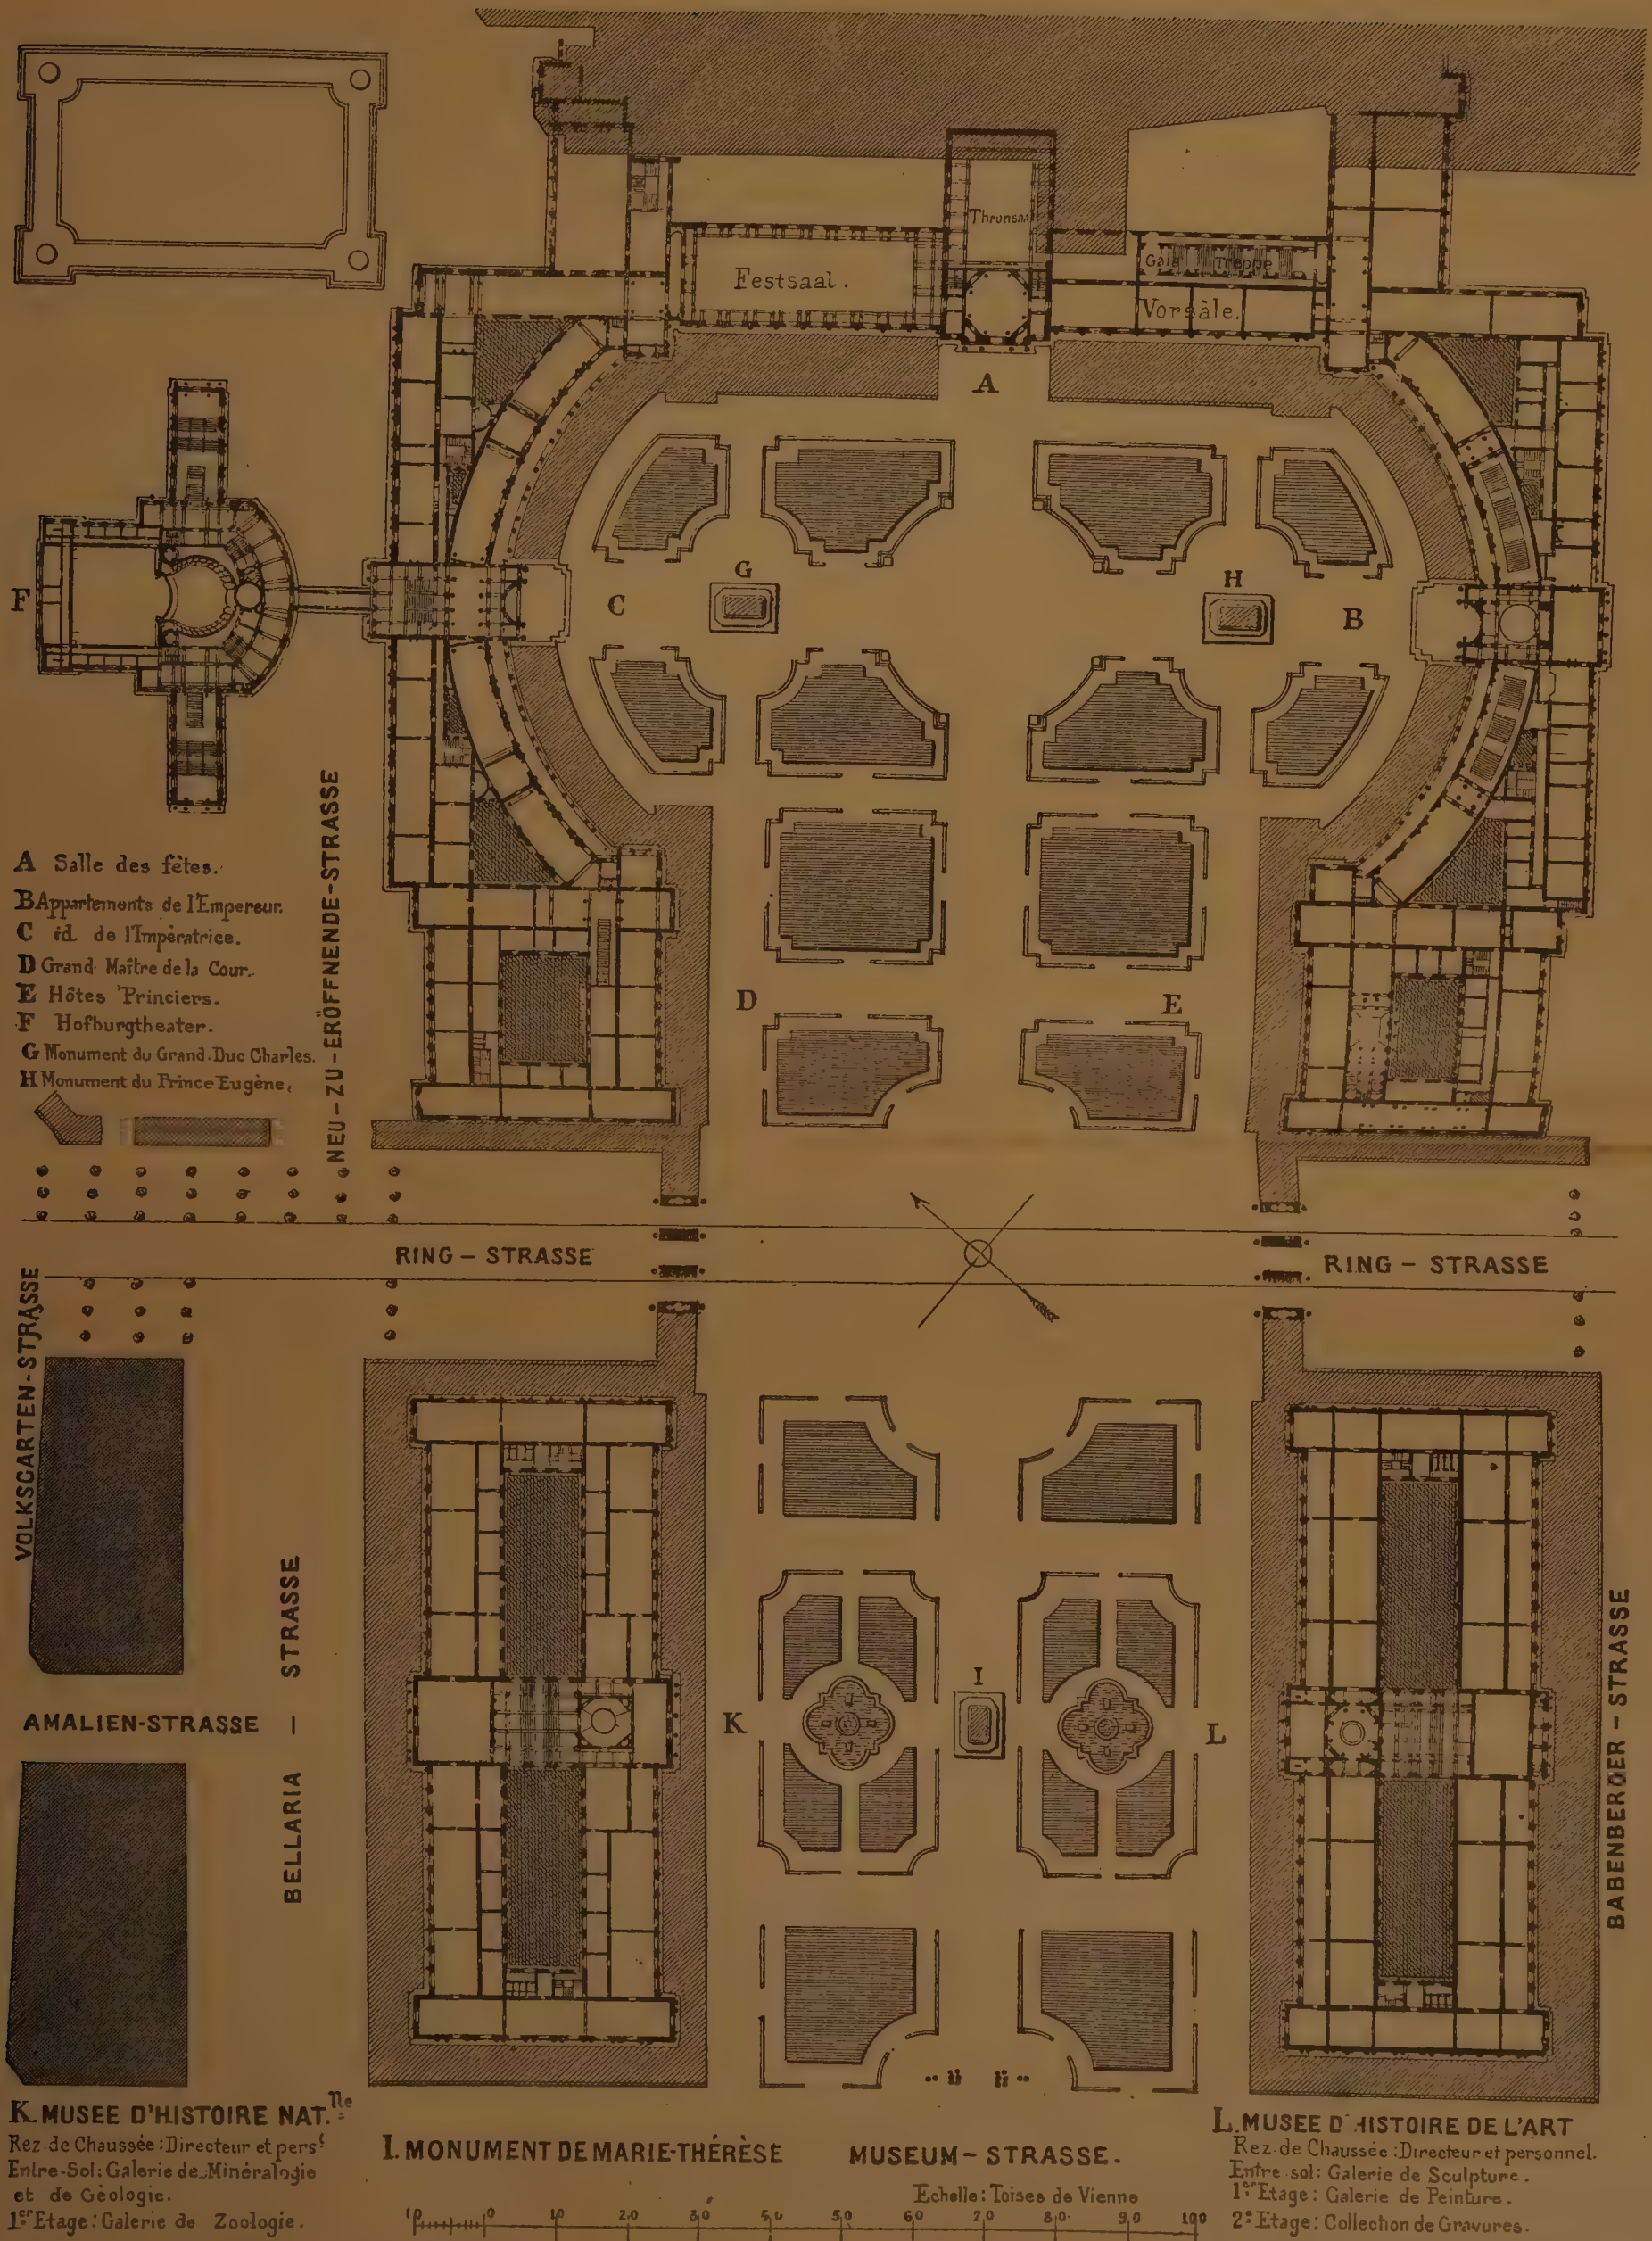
PLAN GÉNÉRAL DU BURGTHEATRE
